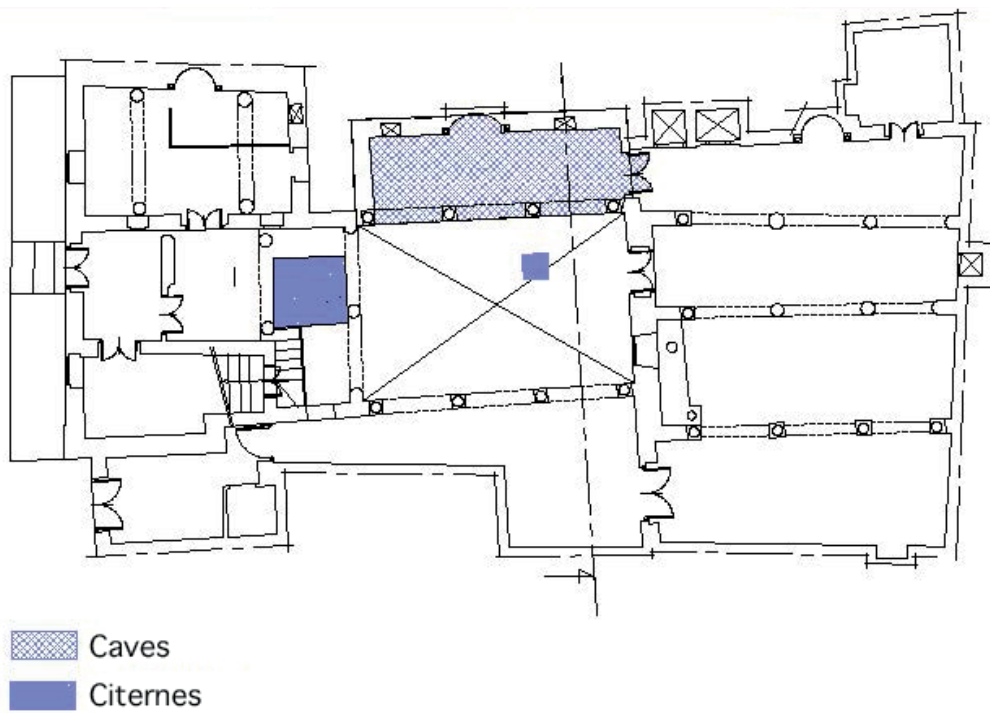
Plan du monument : emplacement des caves et des citernes.
